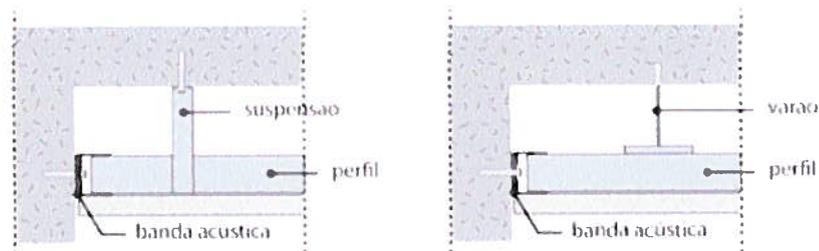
Aplicação de banda acústica entre o suporte e o perfil perimetral.
